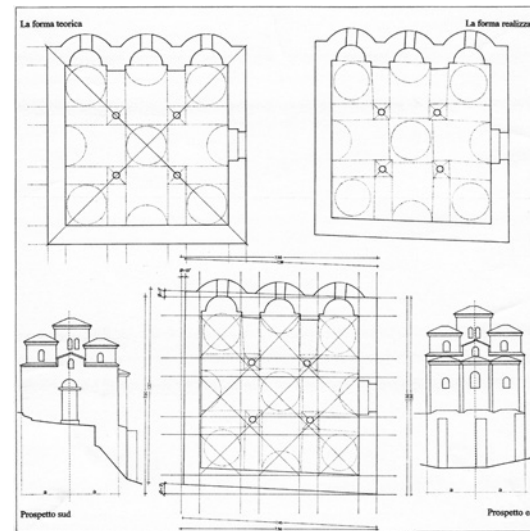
Cattolica di Stilo. Analisi grafico-geometrica delle differenze fra la forma teorica e l'edificio costruito (pianta, prospetto sud, prospetto est).
